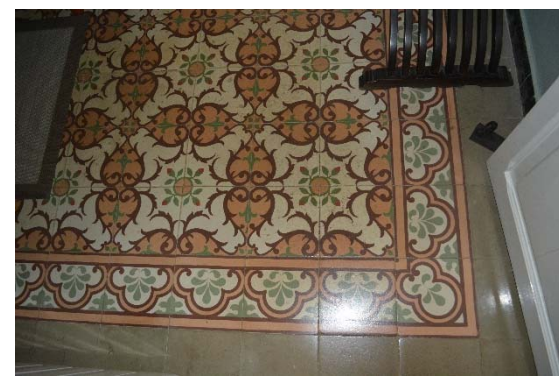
Imagen de pavimento de dormitorio. Fuente propia.
